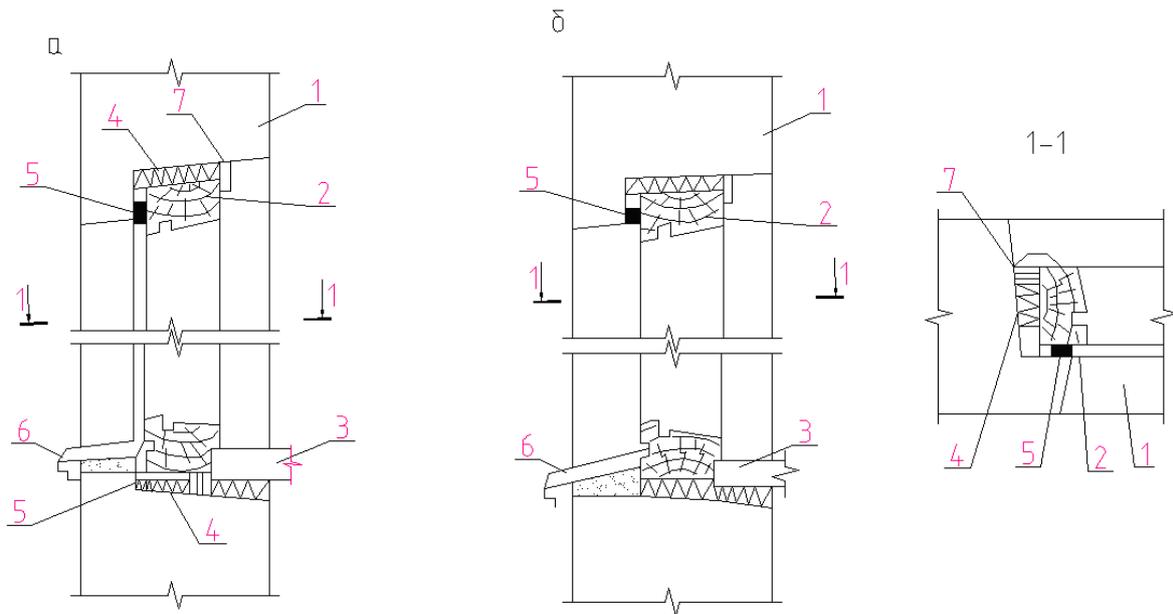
Герметизация мест примыкания оконных блоков к панелям наружных стен: *а* – оконный блок, установленный в заводских условиях; *б* – оконный блок, установленный на строительной площадке; 1 – наружная стеновая панель; 2 – коробка оконного блока; 3 – подоконная доска; 4 – смоляная пакля; 5 – герметизирующая мастика по упругой прокладке; 6 – водосливной фартук; 7 – пакля;
